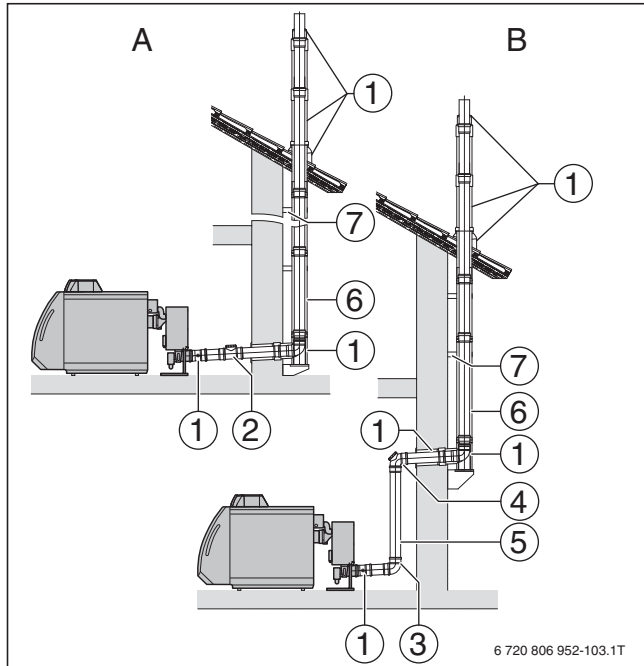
Abgasanlagen zur Schachtinstallation Variante 4 und Variante 5
